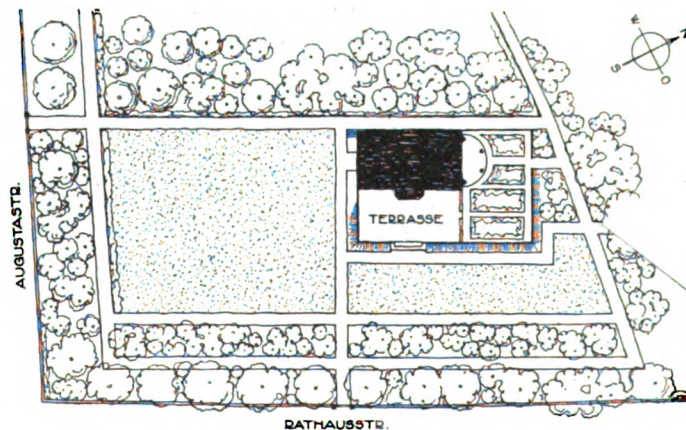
bis 9. Haus Gugenheim. — Grundrisse 1:400, Lageplan 1:1000.
